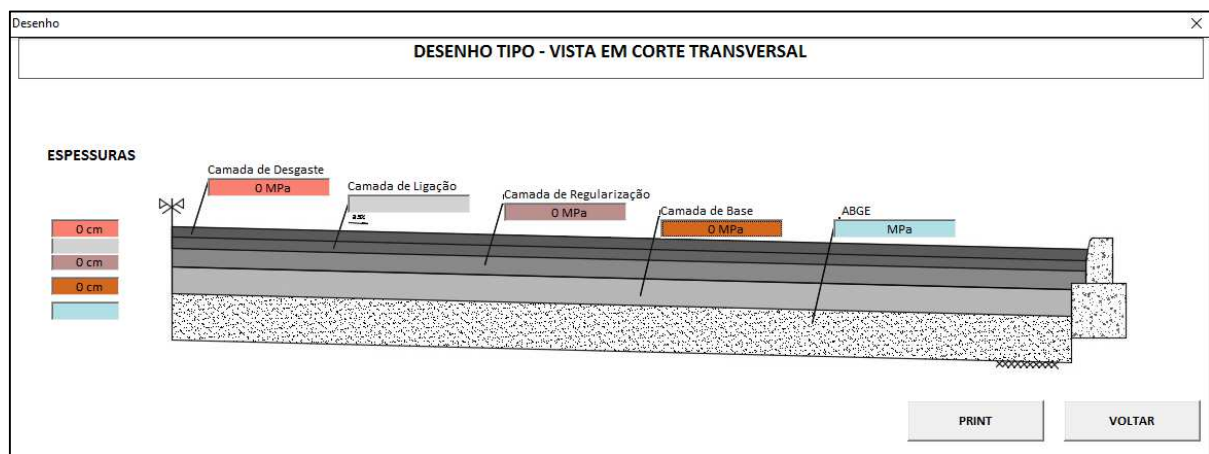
Desenho tipo de um pavimento geral (PAVDim, 2016)
